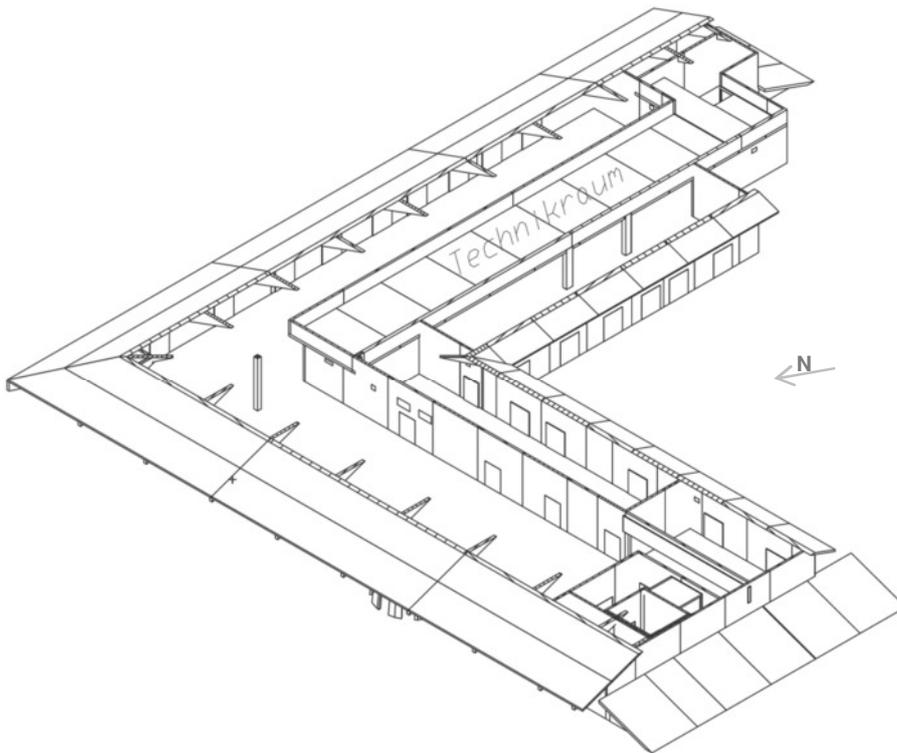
Axonometrie-Darstellung des Dachgeschosses (inkl. Technikraum)
